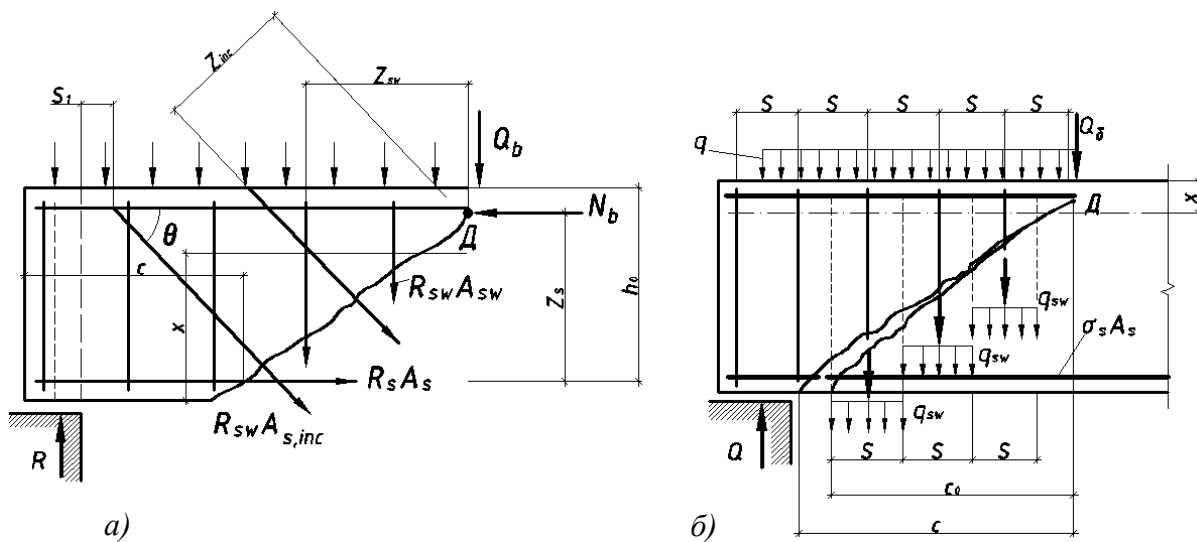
Расчетная схема усилий в наклонном сечении: *а* – схема усилий в сечении с отгибами; *б* – схема усилий в сечении без отгибов
